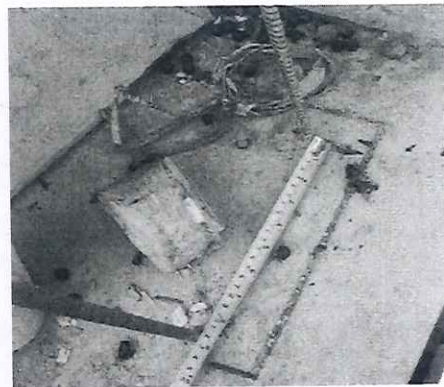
Vista de separación de acero para lavadero 0.22 cm
